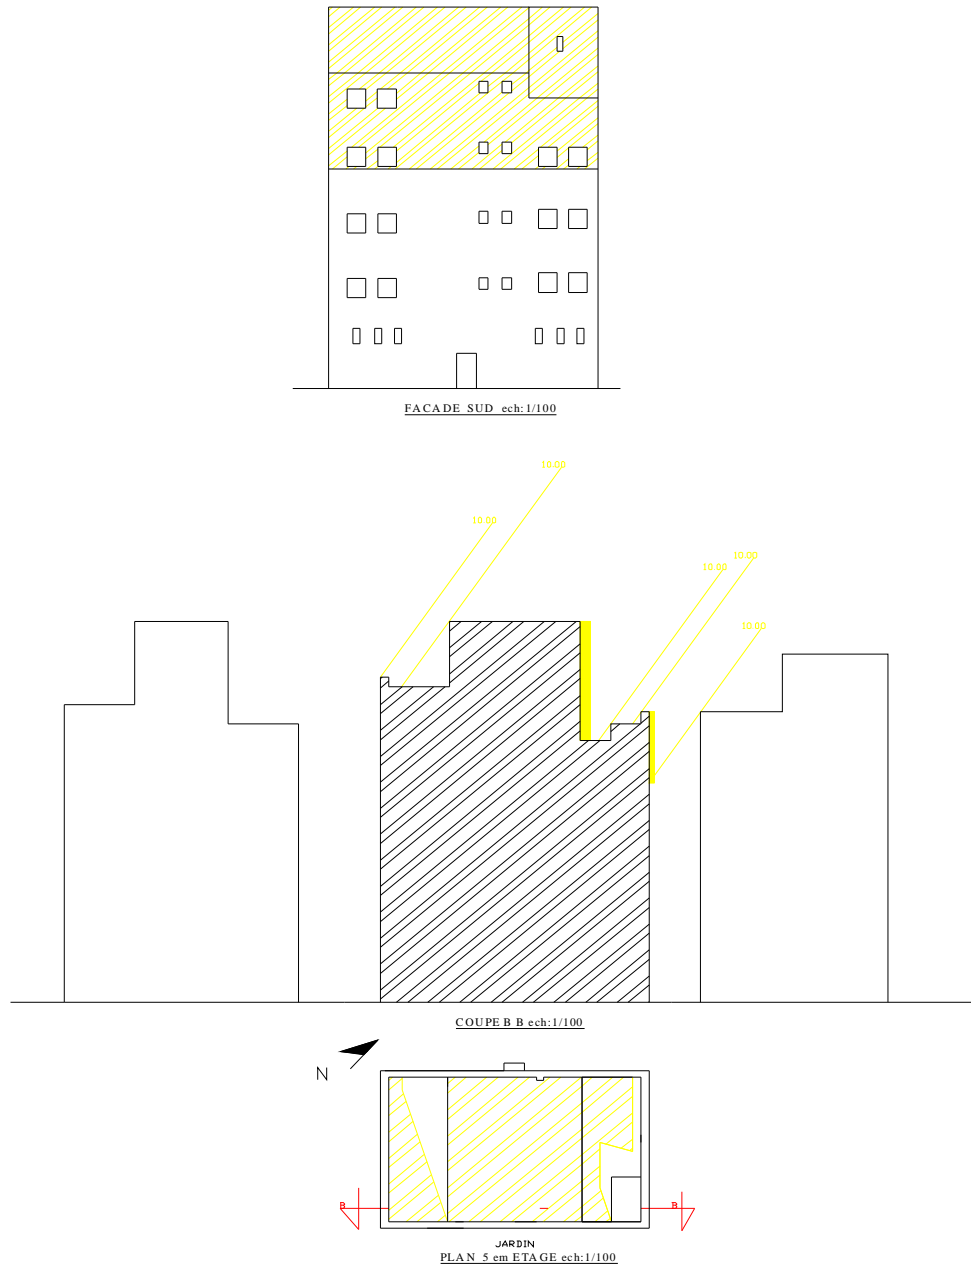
Etude de l'ensoleillement des façades Nord est, et la Toiture a 10 :00 h
